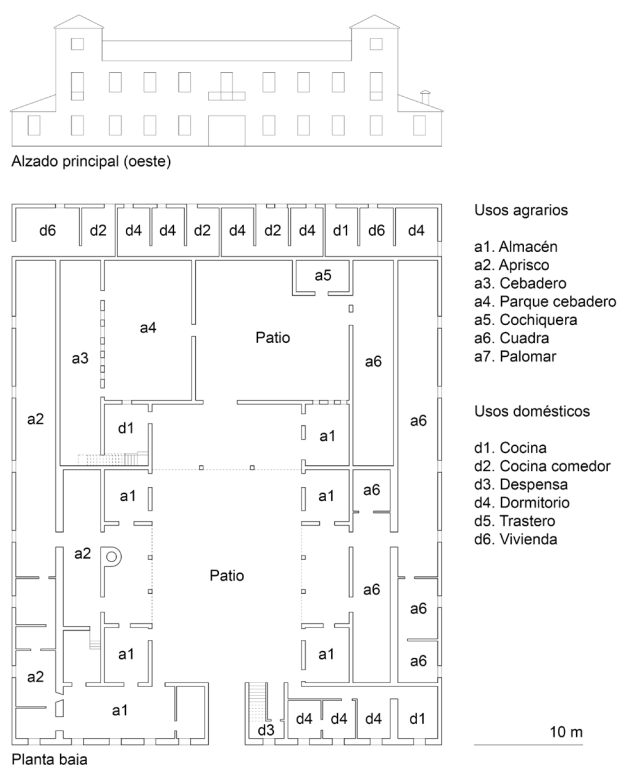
Planta baja y alzado principal de la casa de la Venta o venta del Chaparral que fue demolida para la construcción del pueblo de colonización de El Chaparral. Fuente: Elaboración propia.
